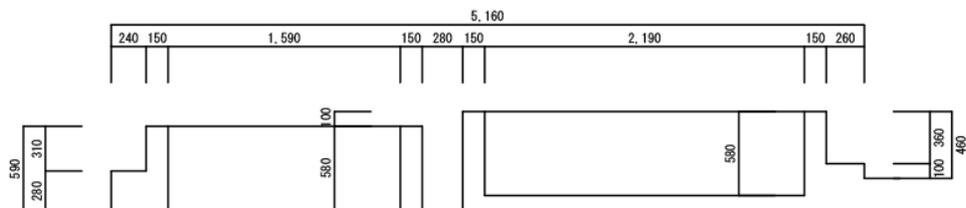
大正村大衆浴場遺構の平面図及び立面図
